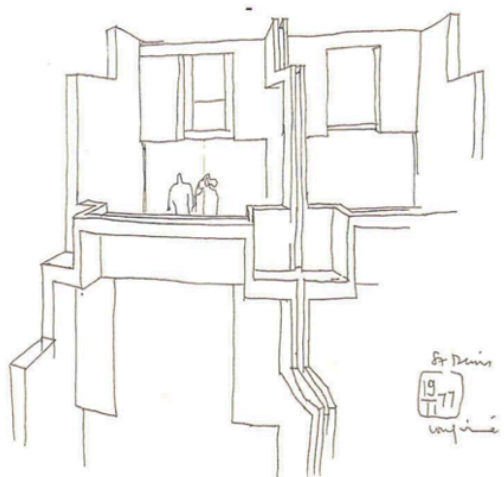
Détail de façade et plan d'étage de l'îlot n° 1, ZAC Basilique (1976-1986), Roland Simounet, arch.
